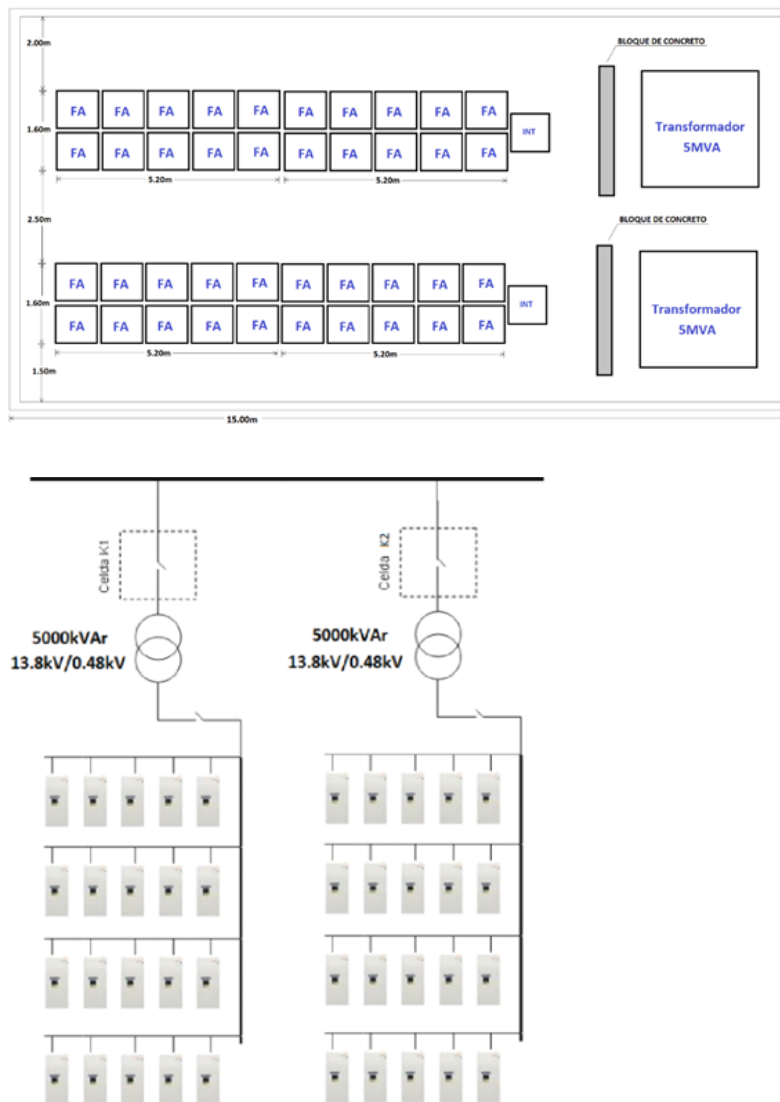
Plano de planta y de distribución de equipos en el sistema filtro activo en MT.
